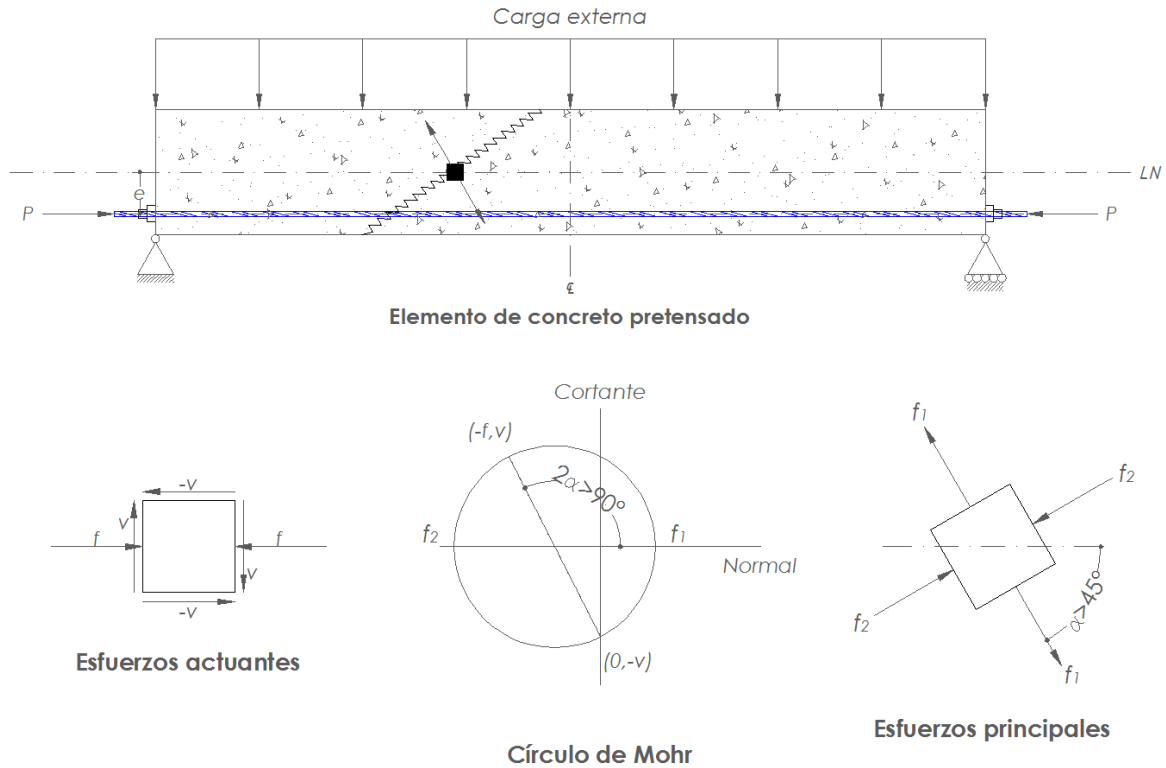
Estado de esfuerzos en un elemento de hormigón pretensado
